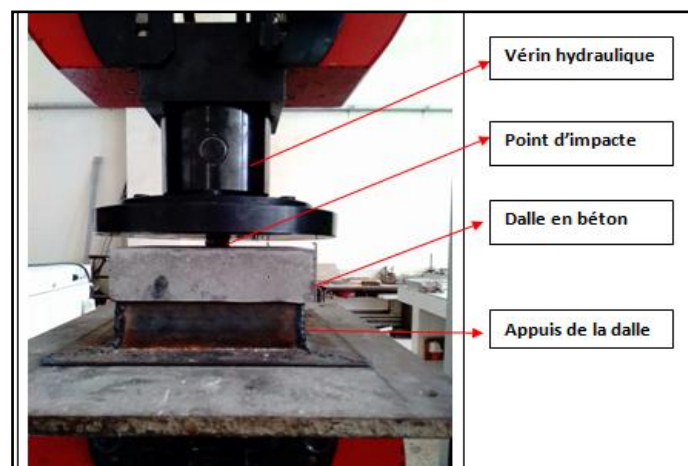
Mise en point du dispositif d'essai de poinçonnement.
